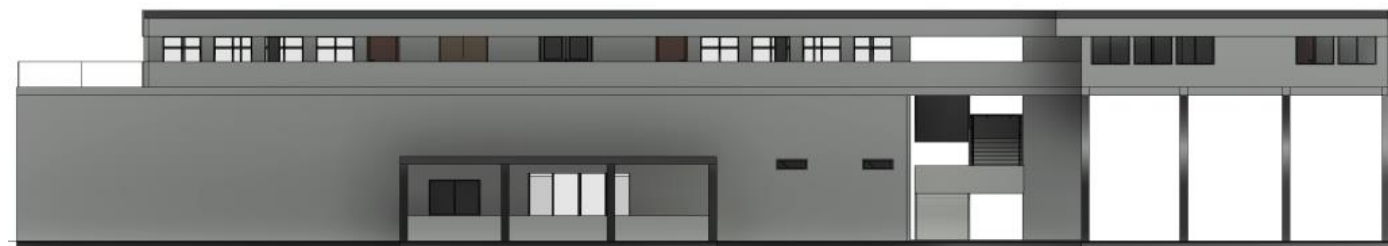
Fachada posterior (Oeste). Elaboración propia.
